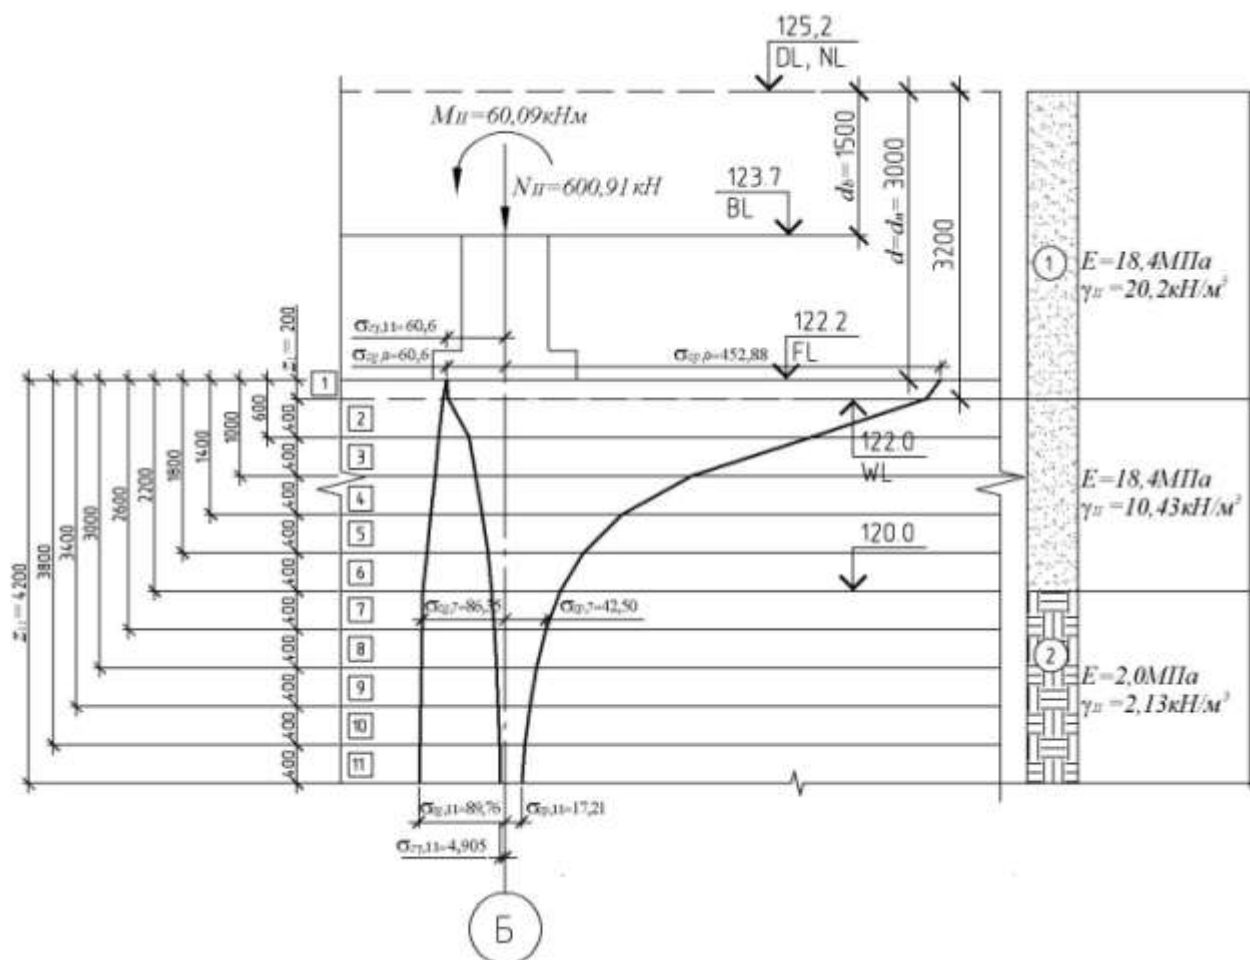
Расчетная схема для определения осадки к примеру 7.7.2
